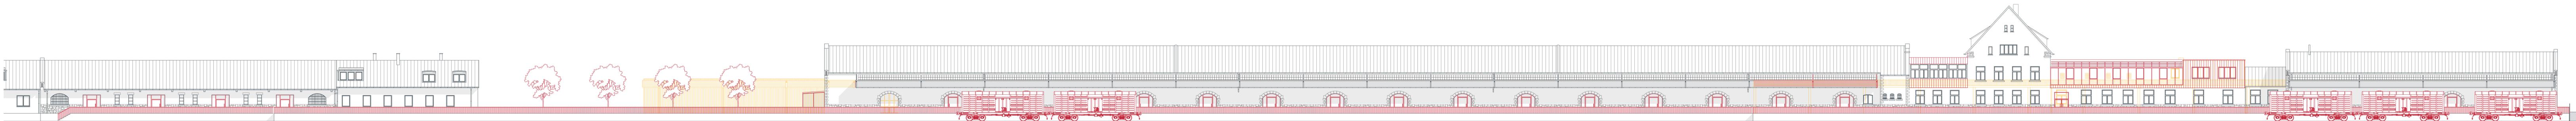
Gesamtanlage: Bauliche Veränderungen, Nord-Ost-Fassade M1:250
